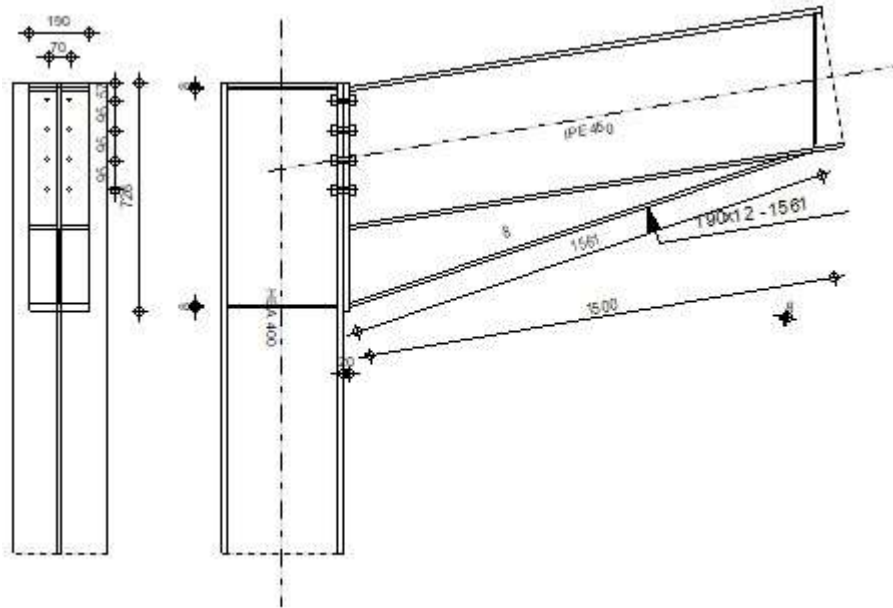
Représentation de l'assemblage Poteau de rive – travers (ferme).
